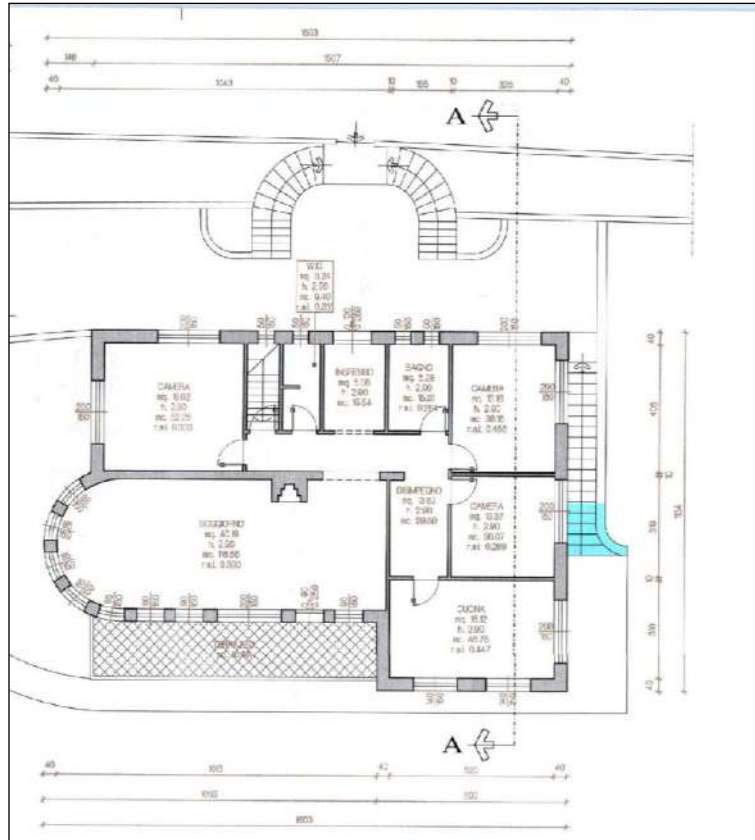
a. Stato approvato abitazione mappale 195 sub. 5: Pianta Piano Terra.
